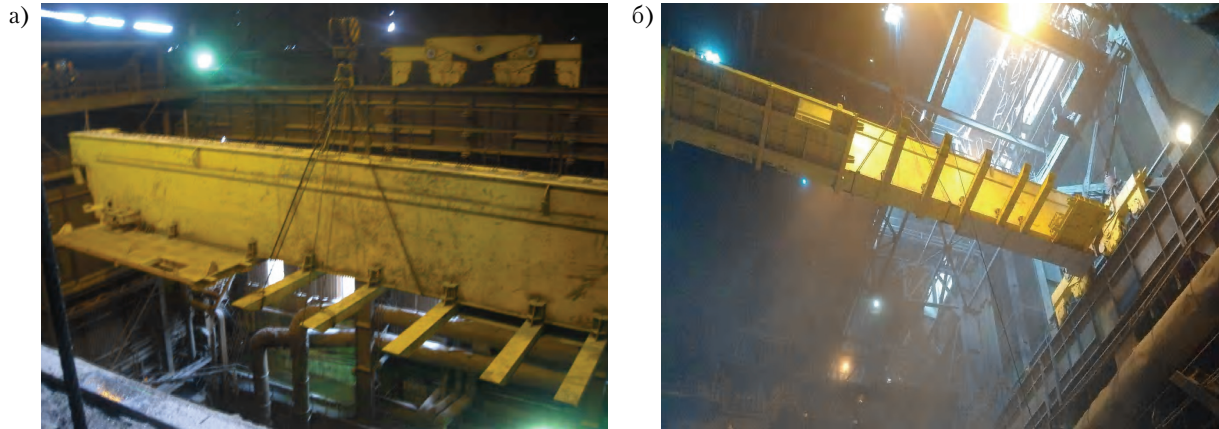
Монтаж главной балки мостового крана весом 70 т: а) подъем балки мостового крана (положение: вдоль конверторного цеха); б) монтаж главной балки на балансирные тележки.
